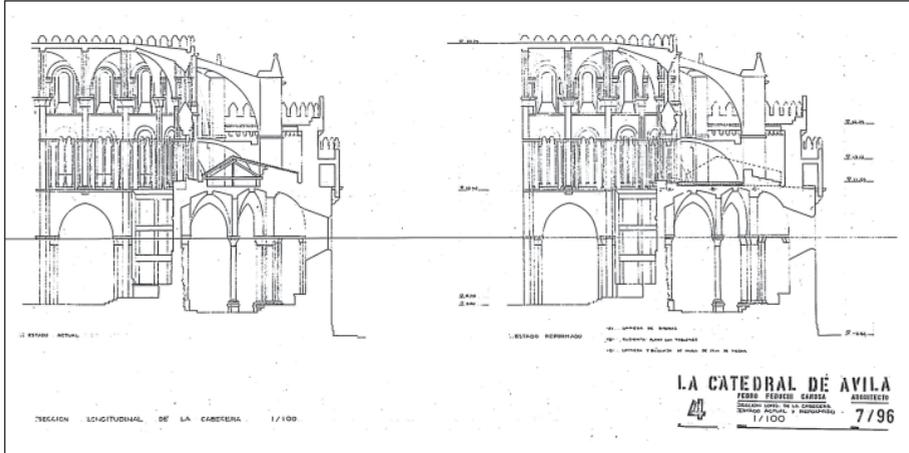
Sección longitudinal por la cabecera donde se muestra el estado anterior y la modificación de las cubiertas del cimorro (Feduchi, 1996).
